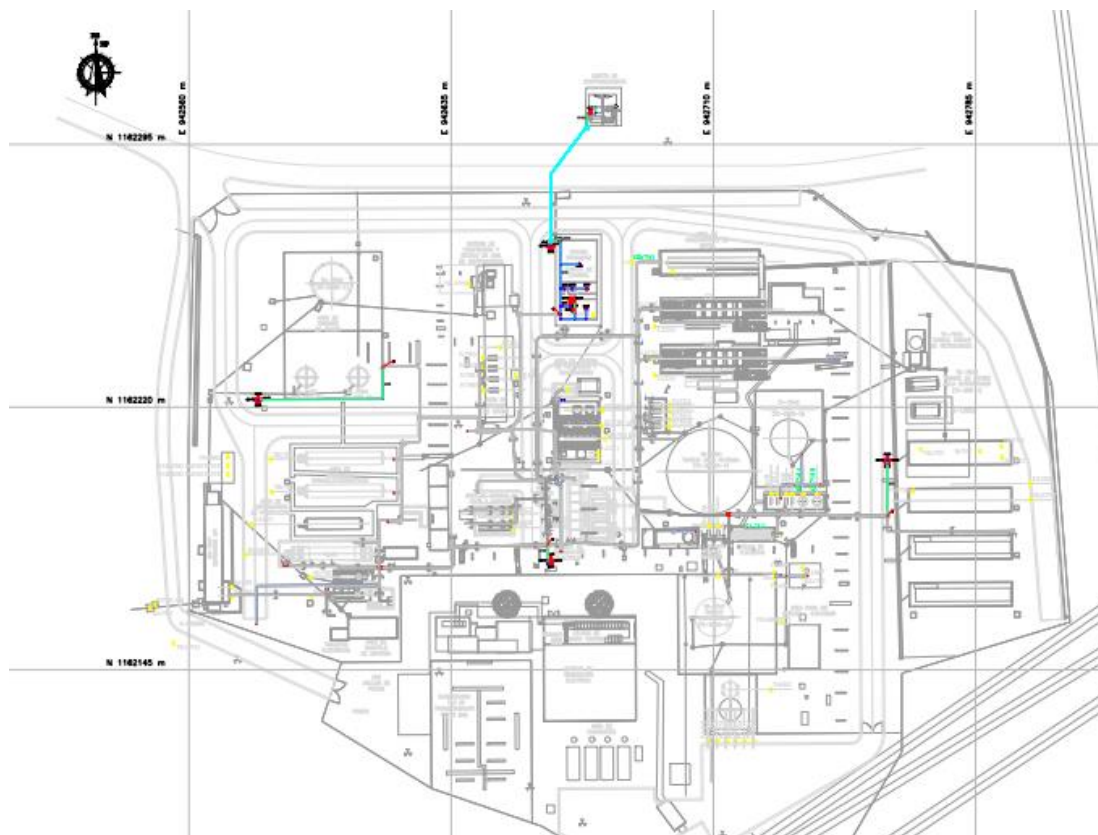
Plano de conduit`s y bandejas porta cables en la planta de separación de crudo, agua y gas, (Pasante, 2019)
